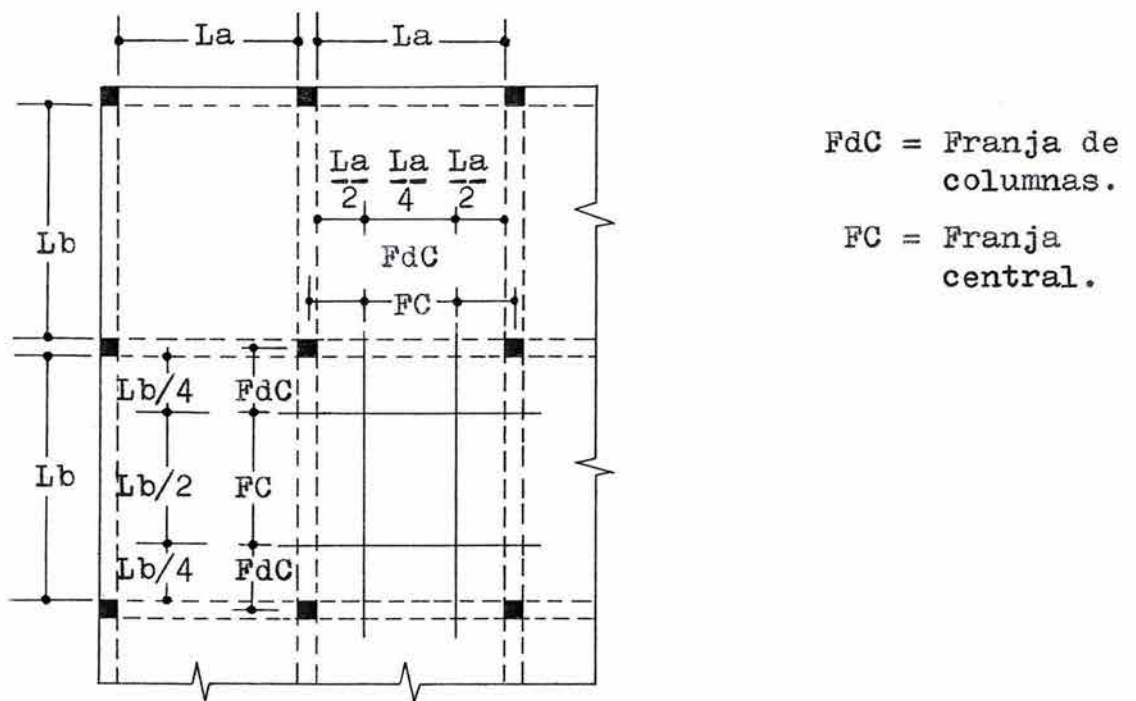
DIVISION DE UN PANEL DE LOSA PERIMETRALMENTE APOYADA EN FRANJAS CENTRALES Y FRANJAS DE COLUMNAS.
